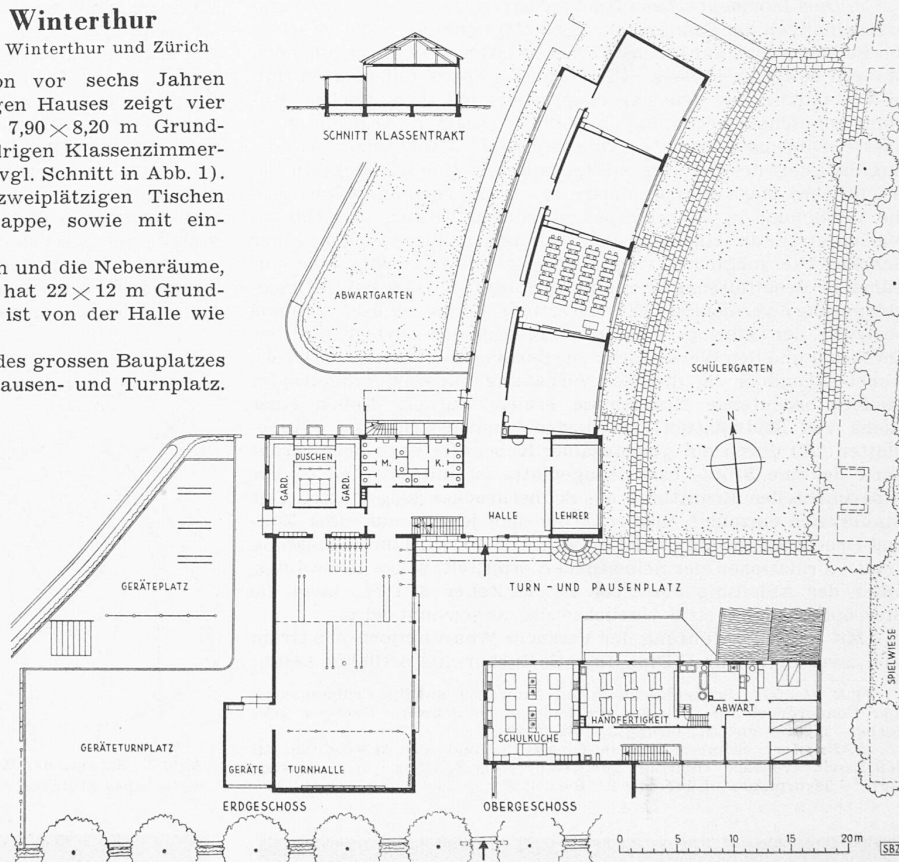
Grundriss Erdgeschoss und Obergeschoss des Mitteltraktes, Masstab 1:600
